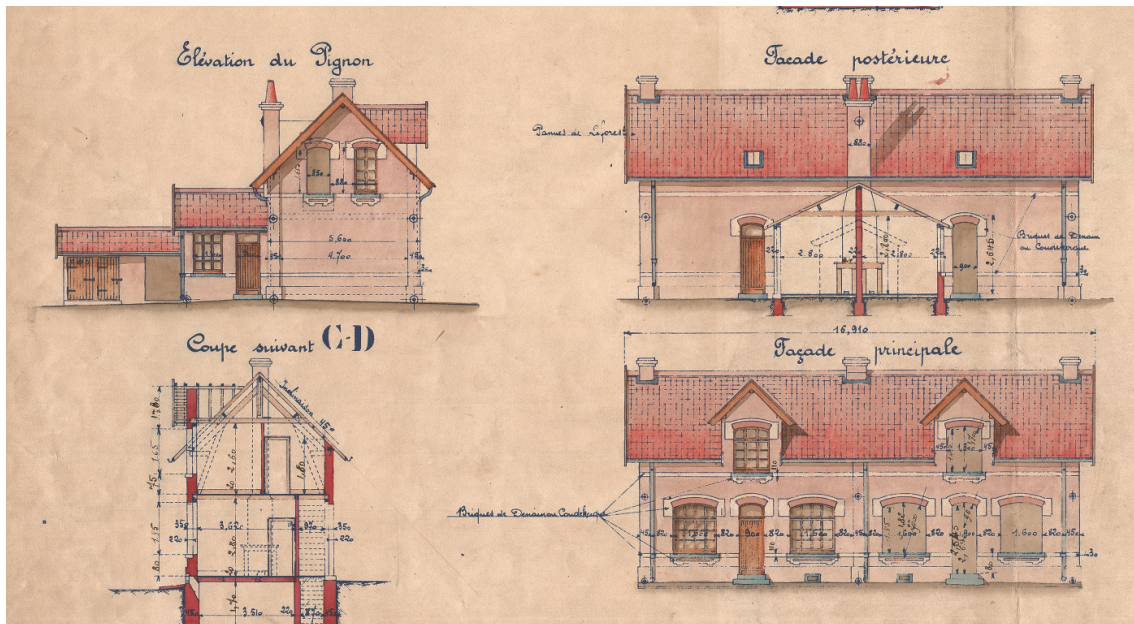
et 10 : Plan logements cité pavillonnaire /source Archives Maisons&Cités
